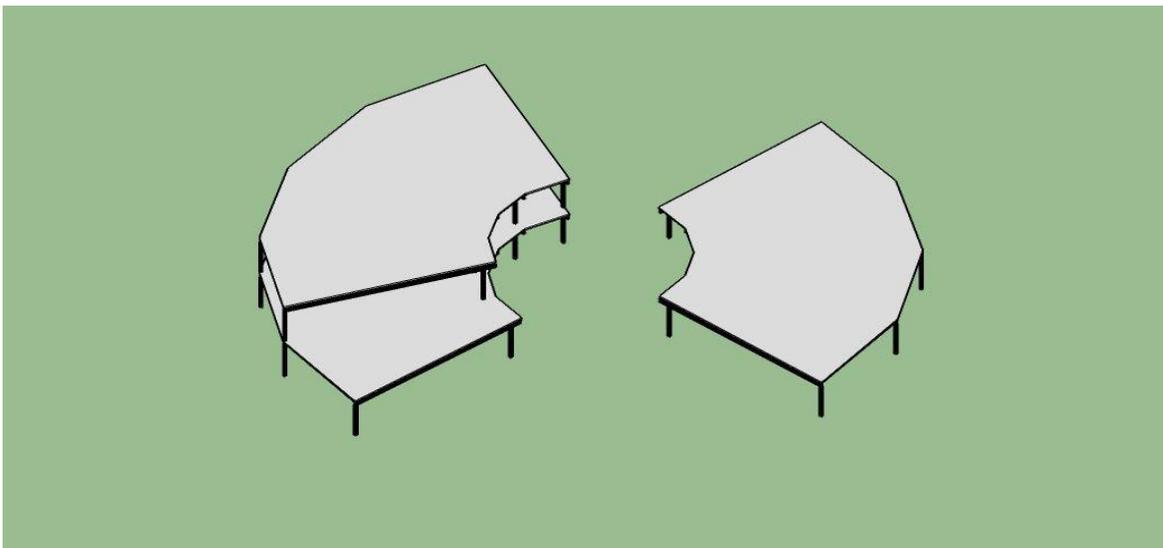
Configuración de losas de planta alta. Imagen propia
